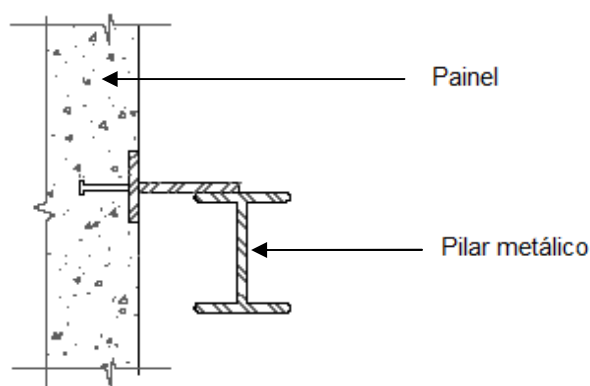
Fixação soldada de apoio lateral, em corte horizontal (PCI, 1989)
